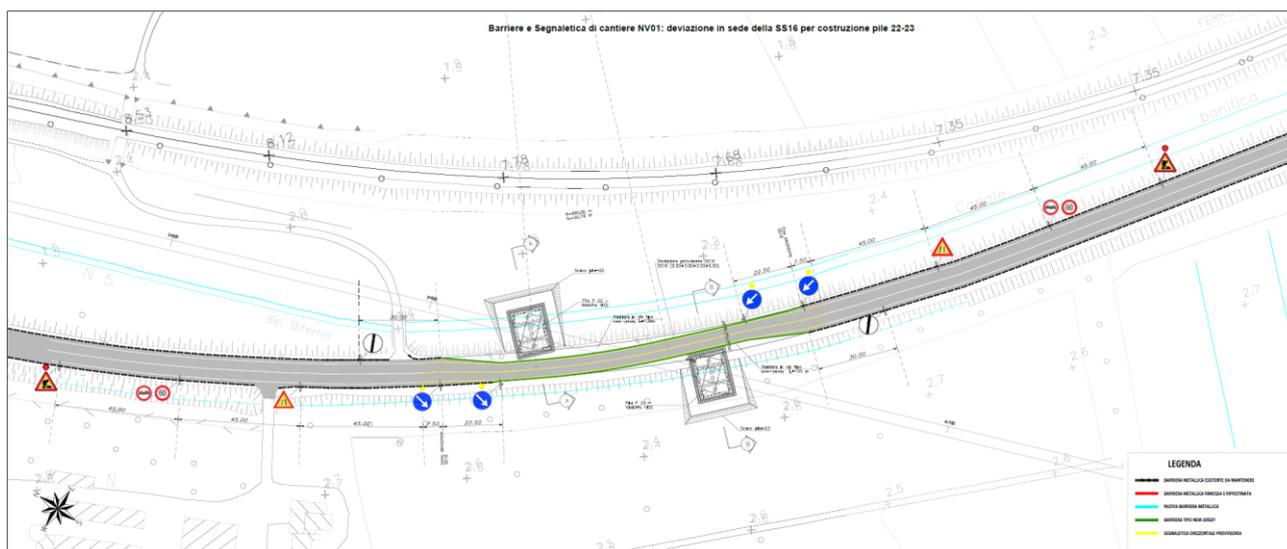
Planimetria segnaletica provvisoria e barriere di sicurezza
